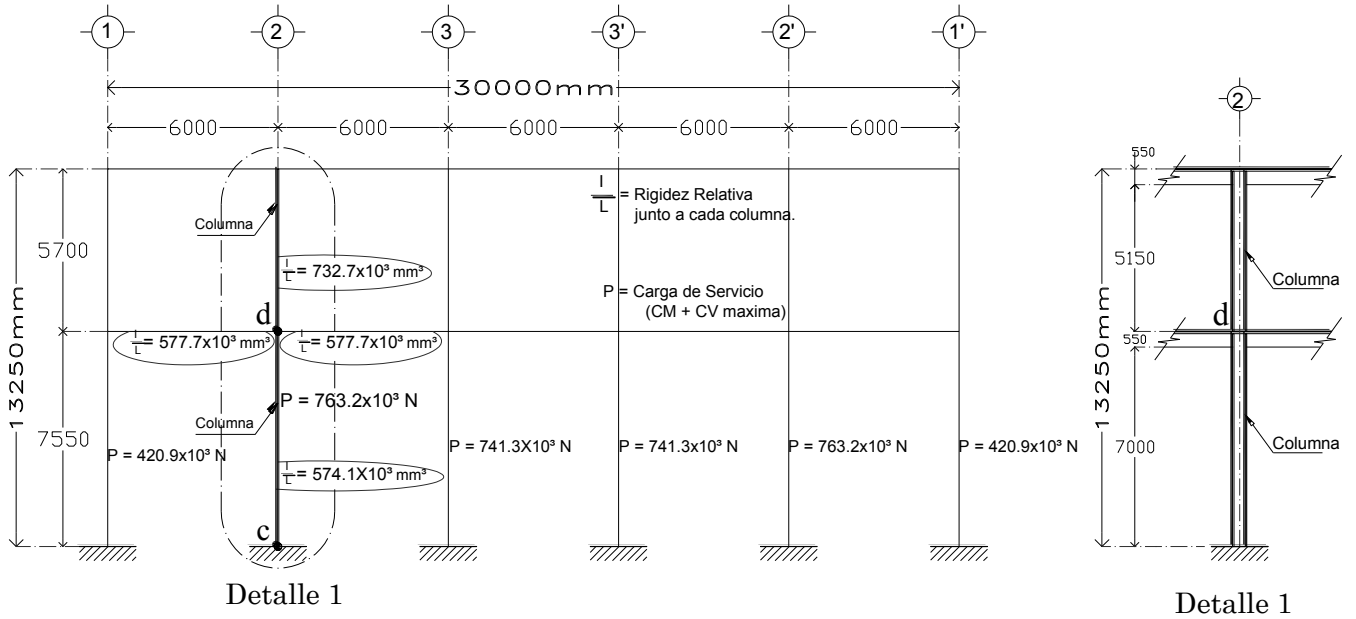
Corte longitudinal (x-x') y detalle 1 de la columna A2.
